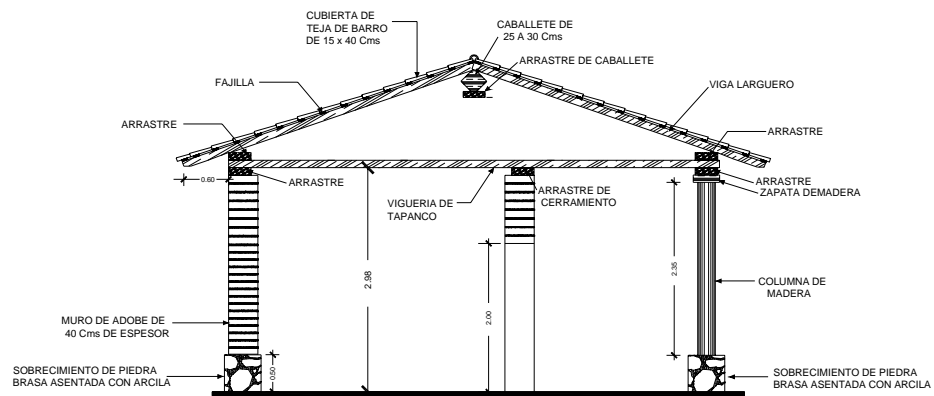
Corte constructivo de la vivienda típica de la región.
